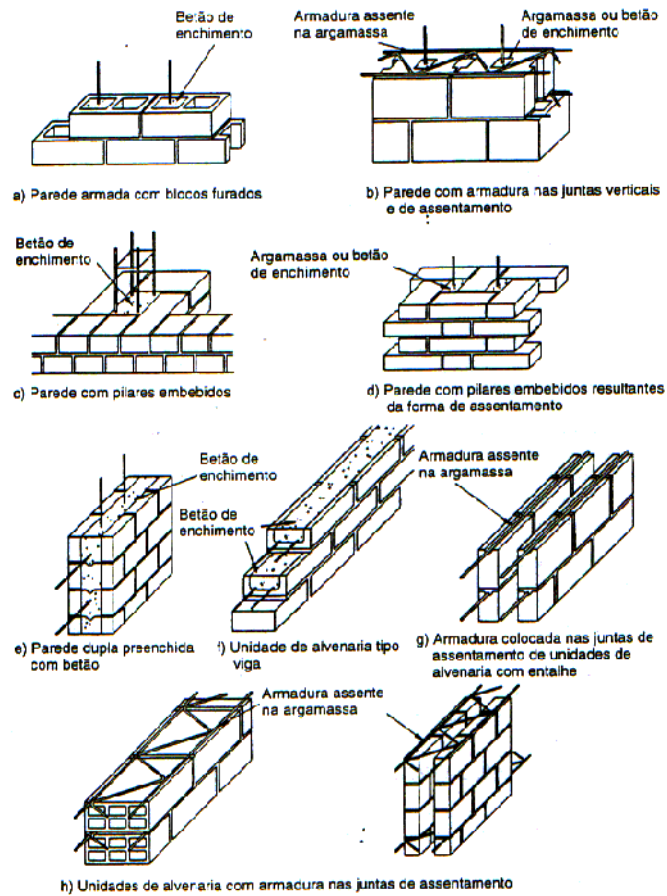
Exemplo de colocação de armaduras na alvenaria
